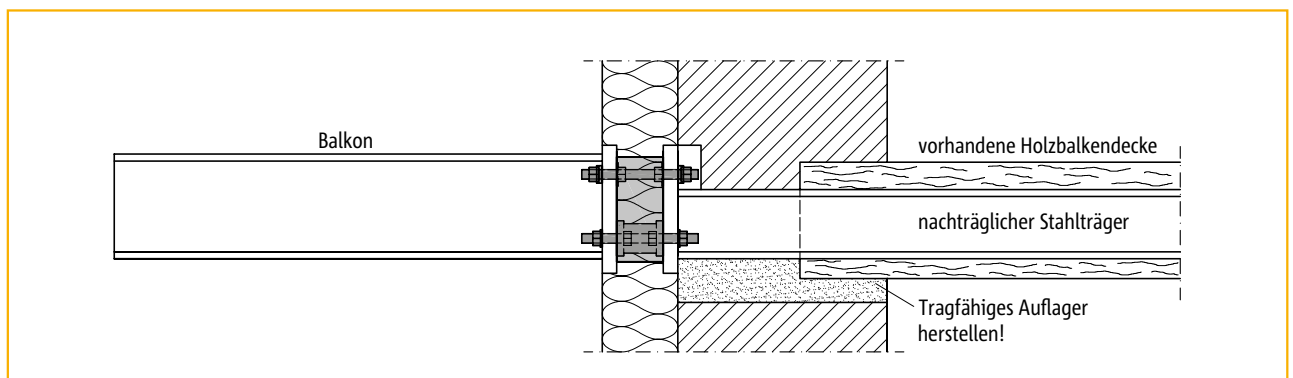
Balkon frei auskragend, angeschlossen mit Typ KST an Holzbalkendecke (Stahlbalkon)
